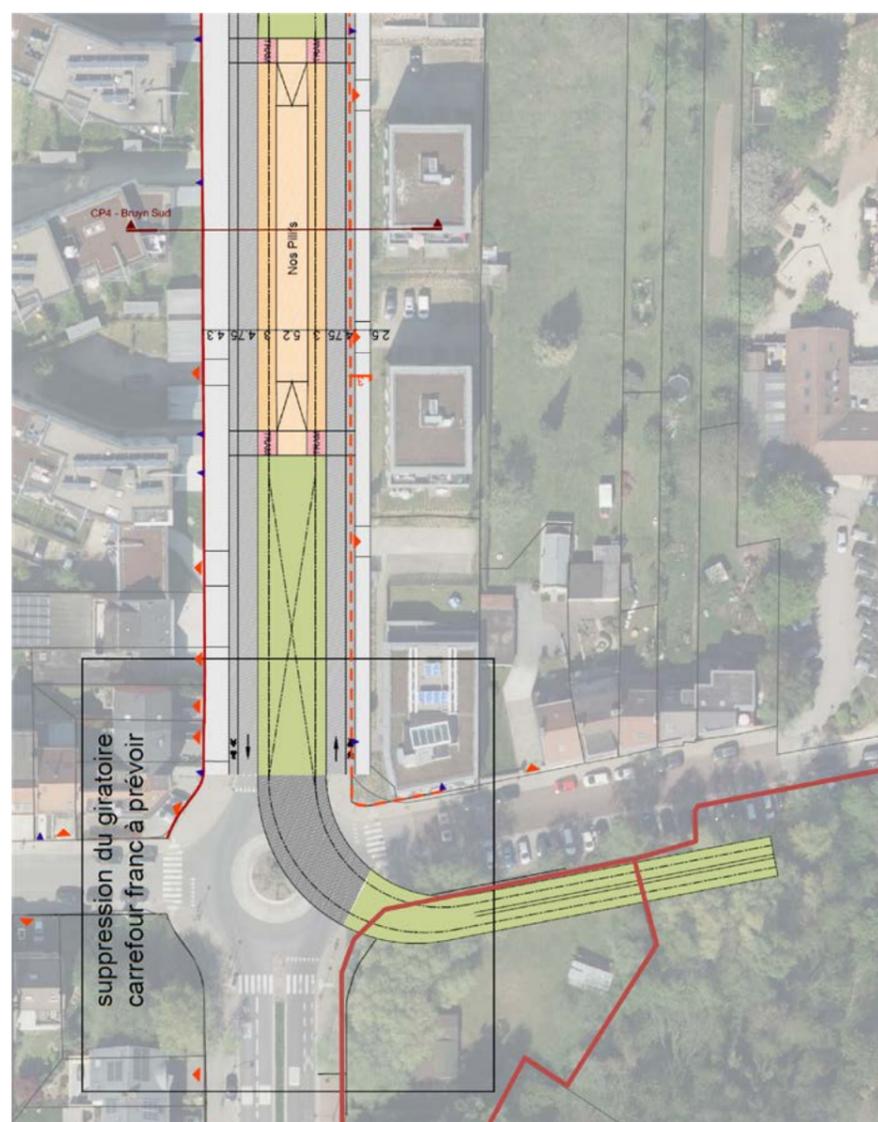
Bruyn - Terminus Pilifs - vue en plan - situation projetée
